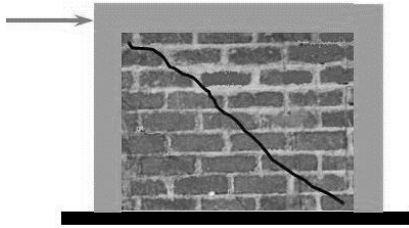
Falla por cortante en muro de mampostería no estructural (Masias, 2002).
